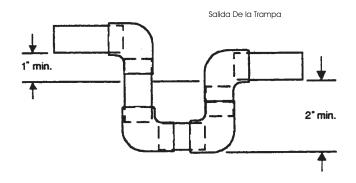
B - Trampa del Condensado (Utilizando Tubería PVC)
